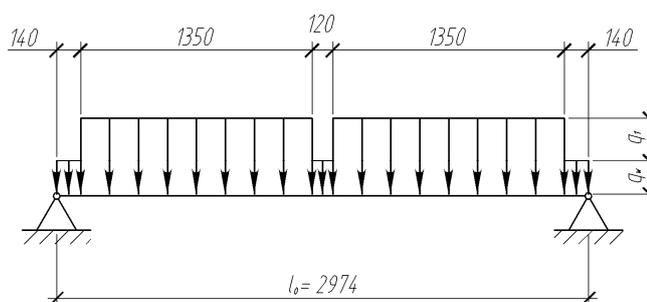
Расчетная схема лобовой балки (ребра)
